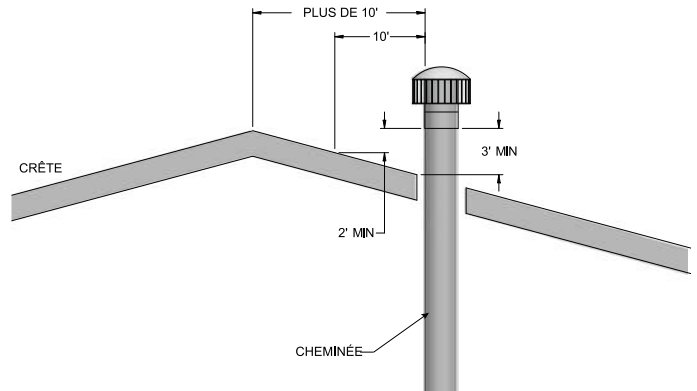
Terminaison de ventilation depuis un toit à double pente - 10 pi. ou plus du bord
